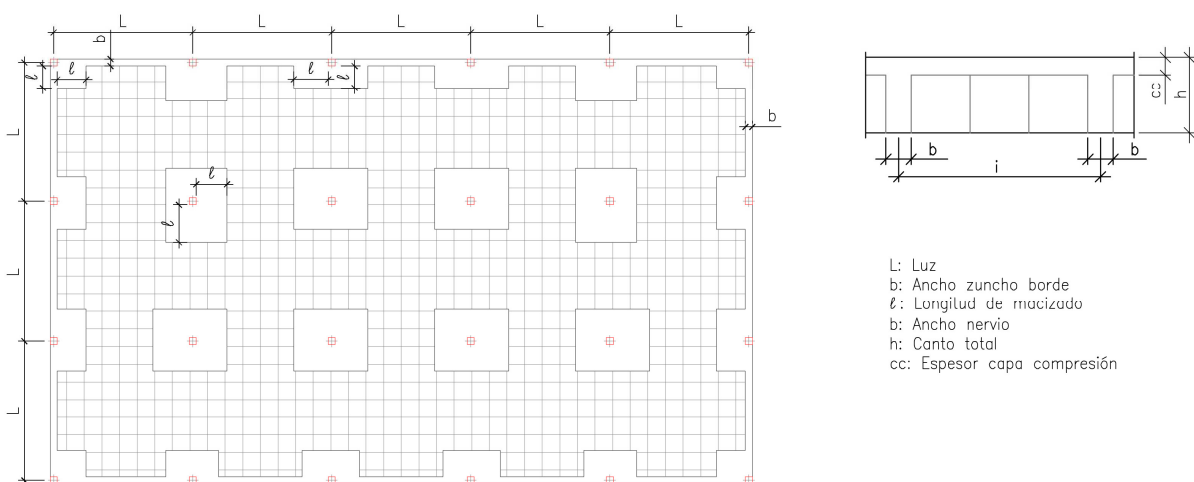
Planta y sección tipo del forjado reticular contemplado.
